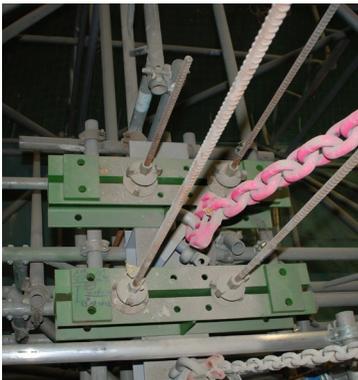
Oberer Hängepunkt einer Abhängung mit Gewindestäben
